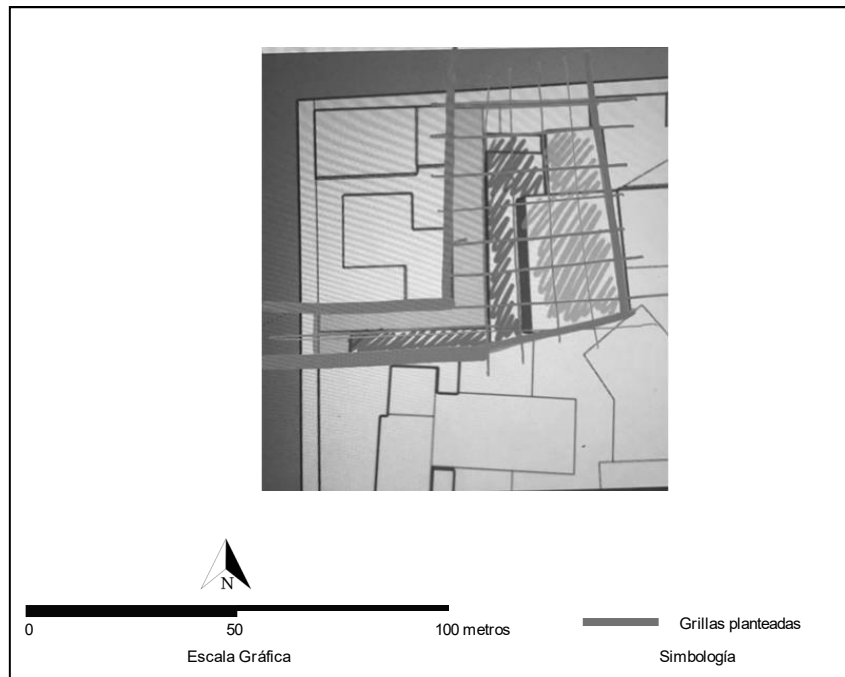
Croquis de las grillas planteadas en el proyecto, así como la posible modulación estructural.
